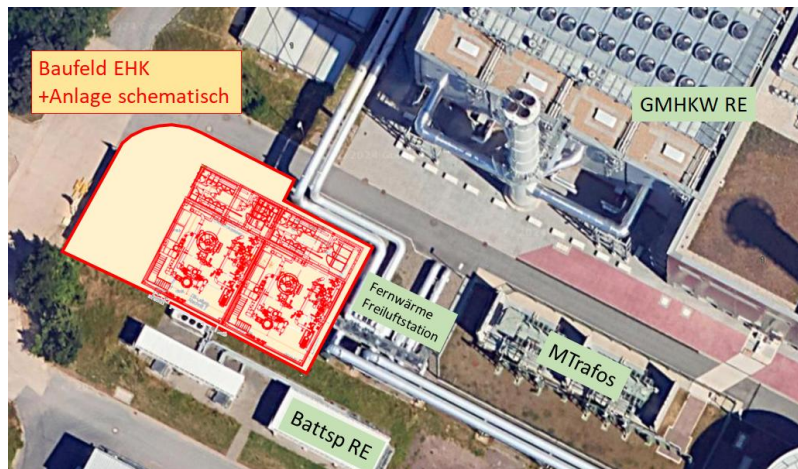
Luftbild mit Lageplan Baufeld und schematischem Gebäudeentwurf
